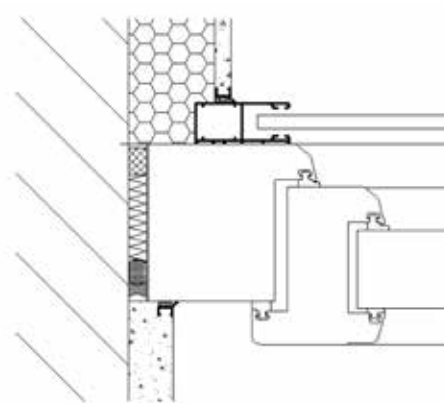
Anschlussdetail mit Führungsschiene A3 - R
